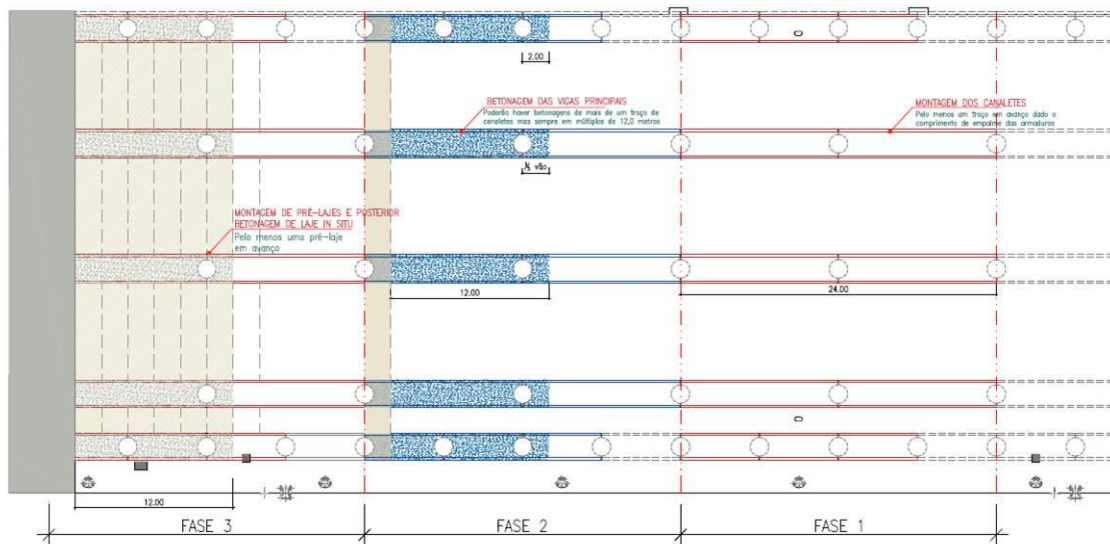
Sequência construtiva do tabuleiro antes da betonagem "in situ"
